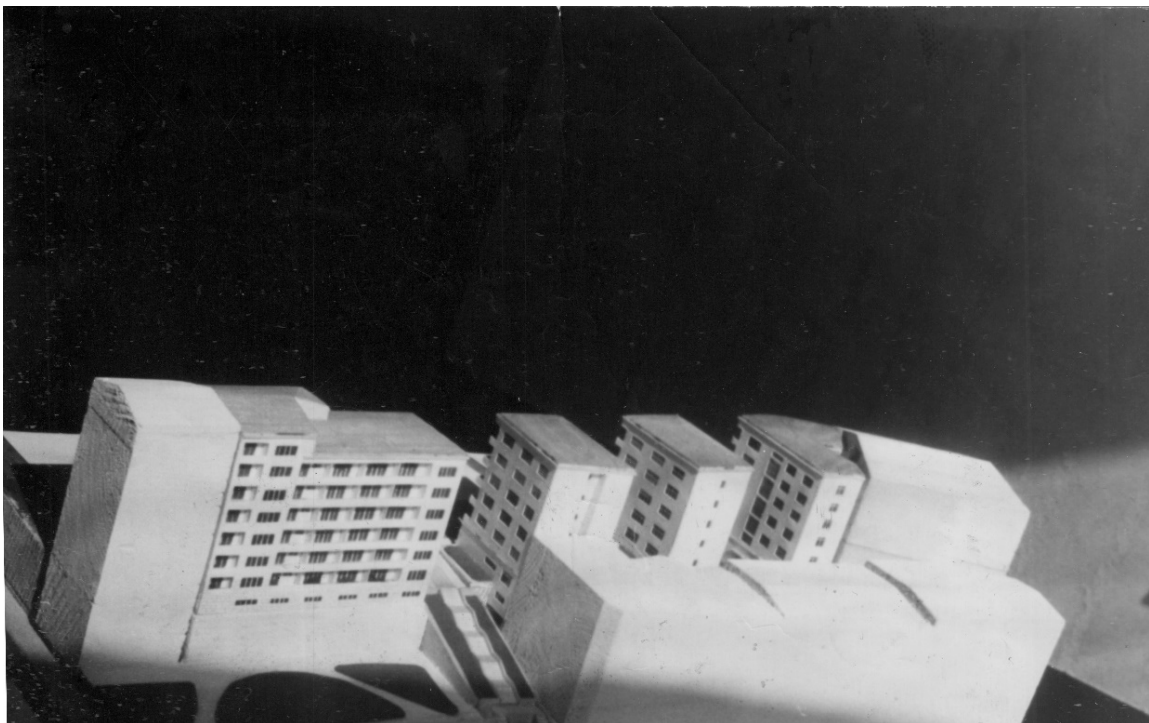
Zdenko Kolacio, Građevni plan stambenih višekatnica na području Potok, revizija plana Josipa Petraka, Rijeka, 1950.
